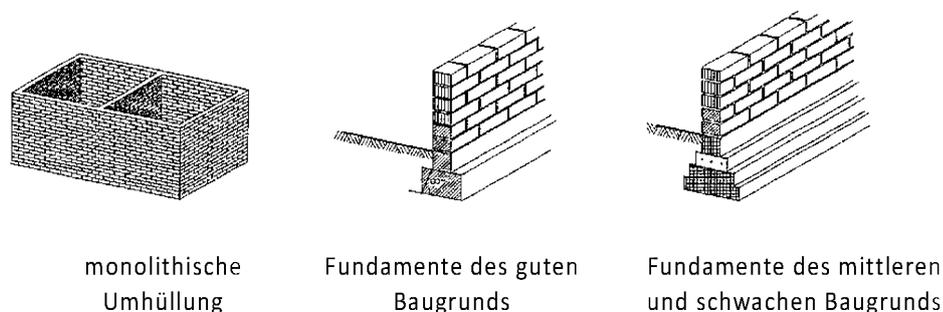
Lehmsteinwand-Fundamente verschiedener Baugründen
